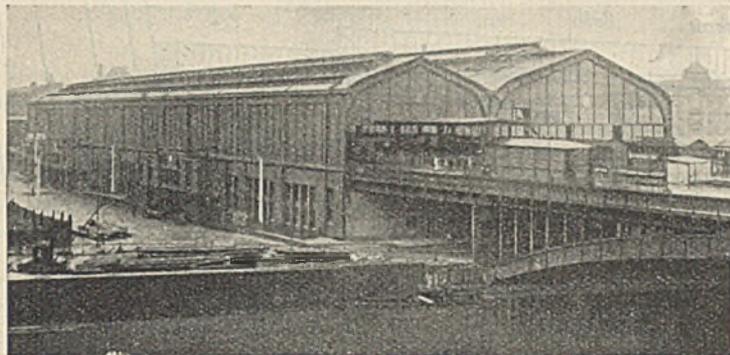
Bahnhof Berlin Friedrichstraße. Gesamtansicht.
